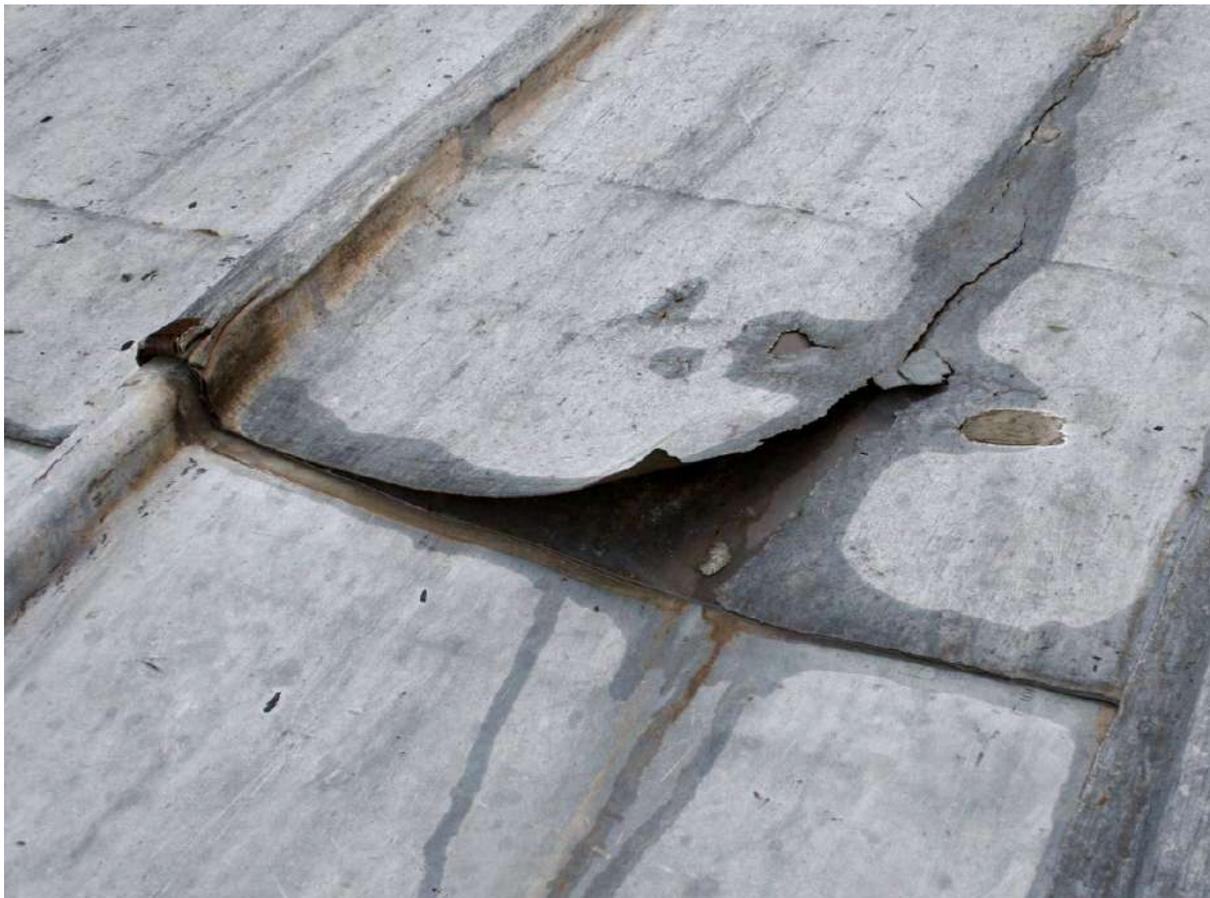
Una lastra parzialmente sollevata e fratturata dall'azione del vento.
